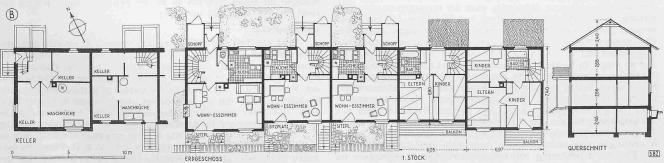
Grundrisse und Schnitt der Fünfhäusergruppe, Typ B
